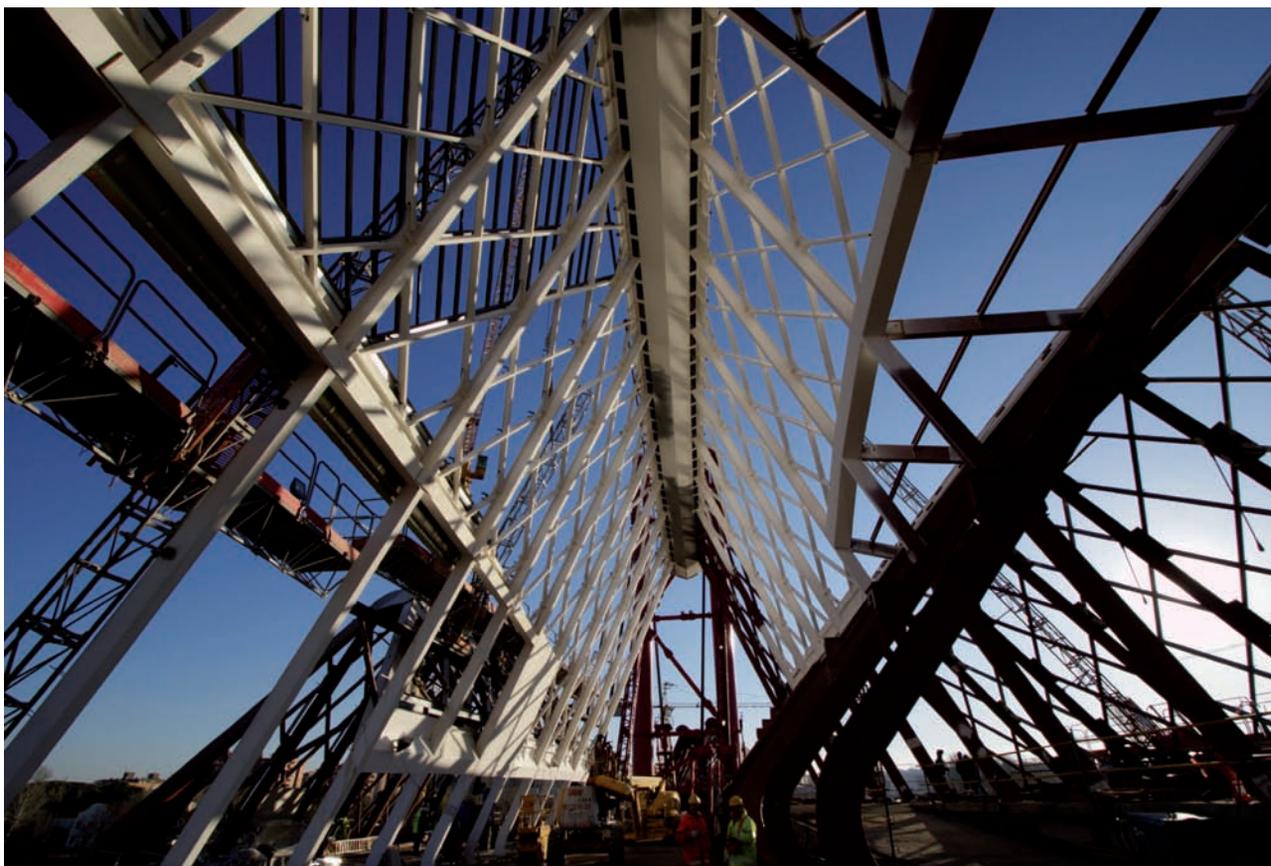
Secuencia de montaje de la estructura metálica de la parte norte.
